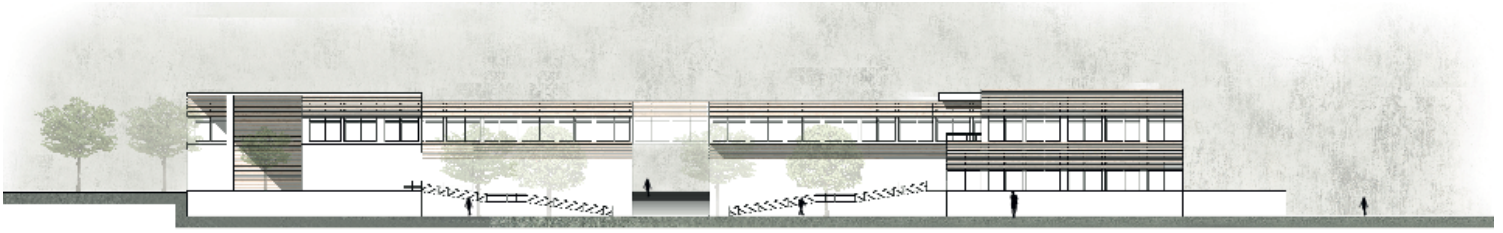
FACHADA ESTE (Elaboración Propia)
